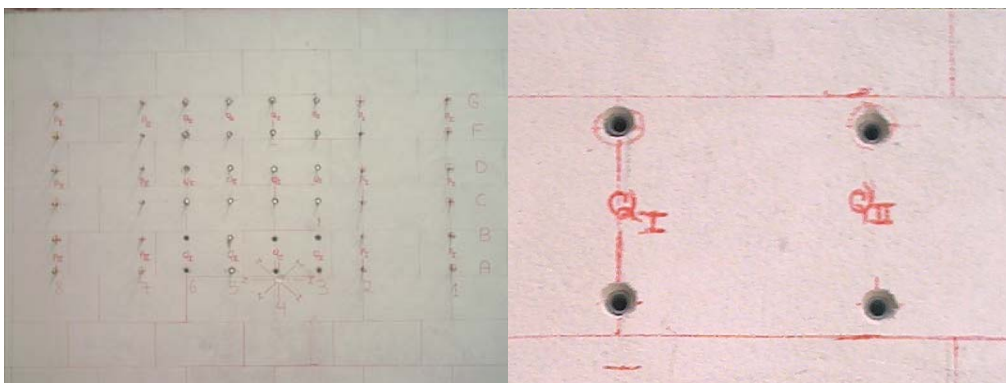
Aplicação das fixações na parede experimental e exemplo de localização das fixações em junta vertical e em zona corrente do bloco
